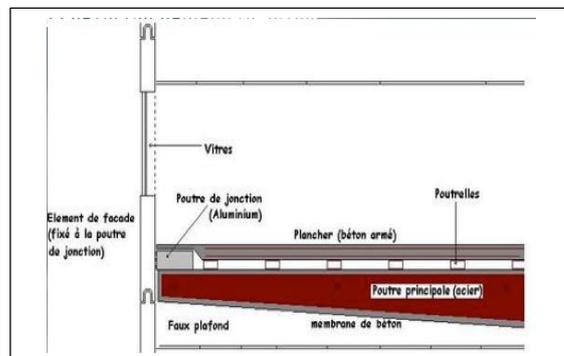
Coupe montrant les éléments d'une structure à noyau central¹⁰
